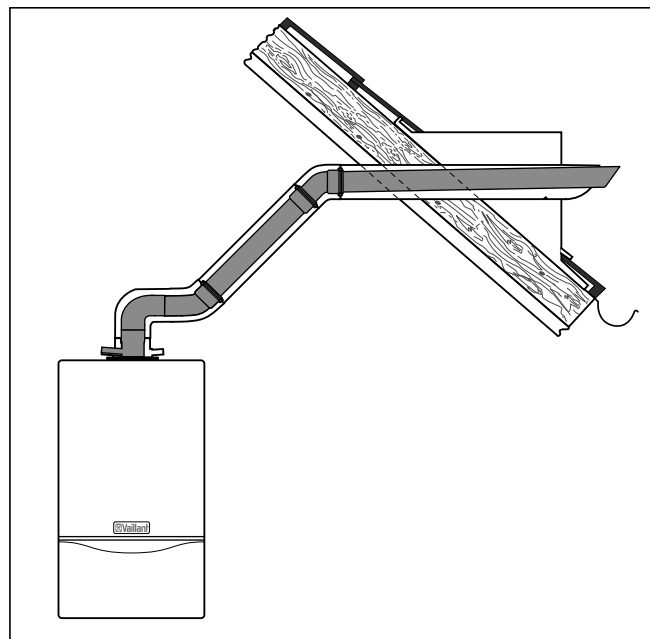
Exemple de montage : traversée de toit horizontale
